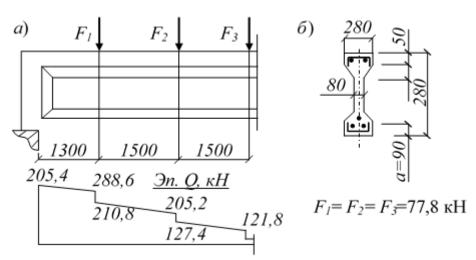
Схема приложения нагрузки и размеры железобетонной балки
